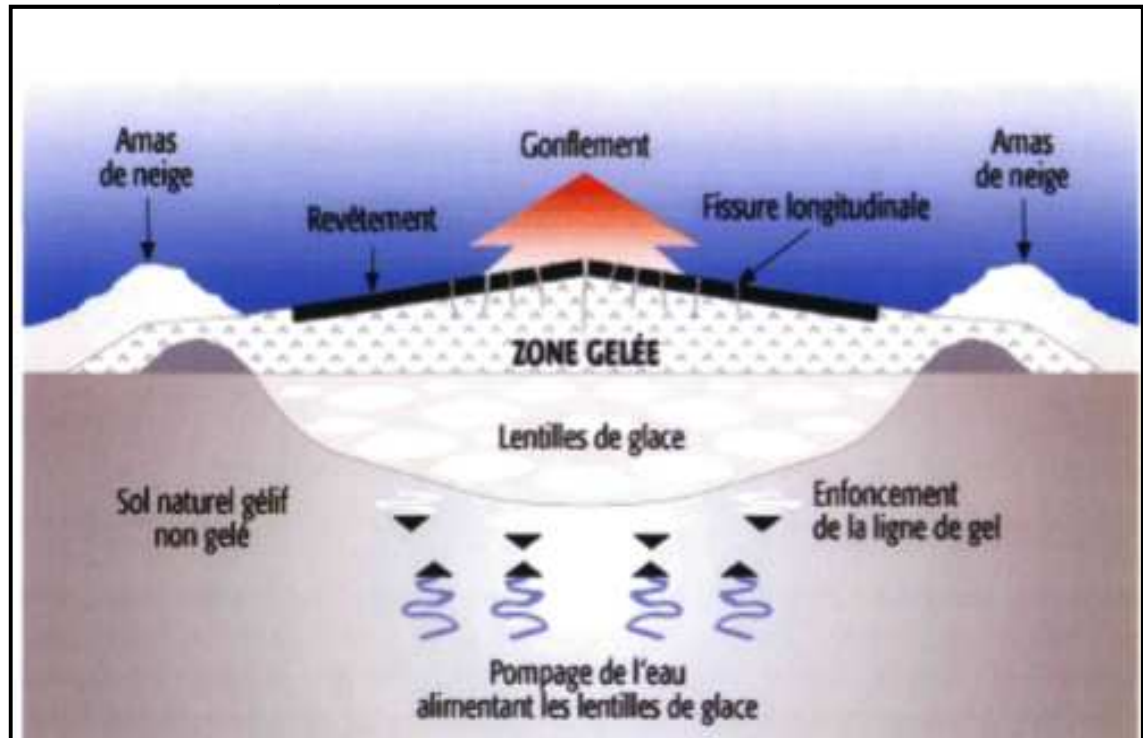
Action du gel sur une chaussée routière (ALDALATI.R, 2014).
